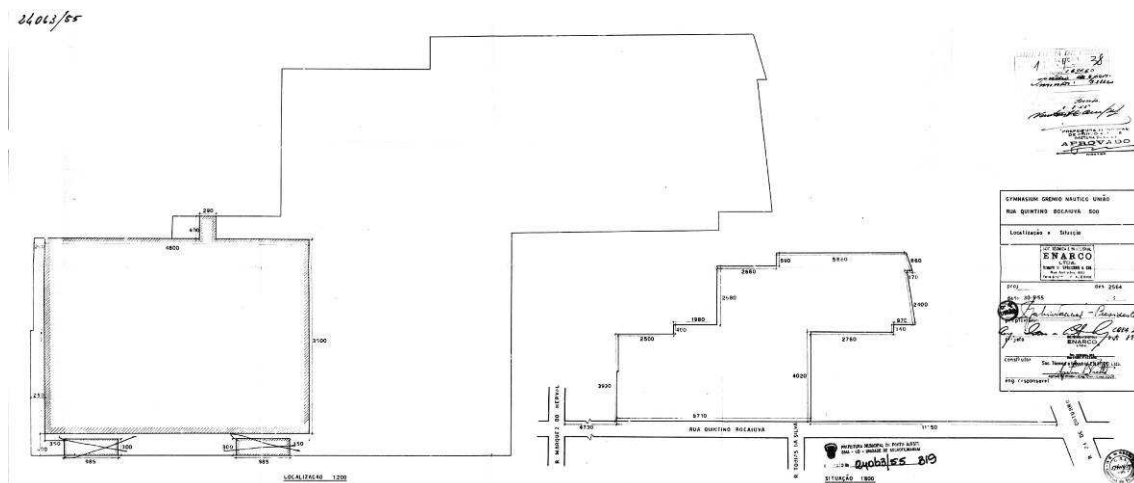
Plantas de situação e localização. (Fonte: Arquivo Municipal de POA)
